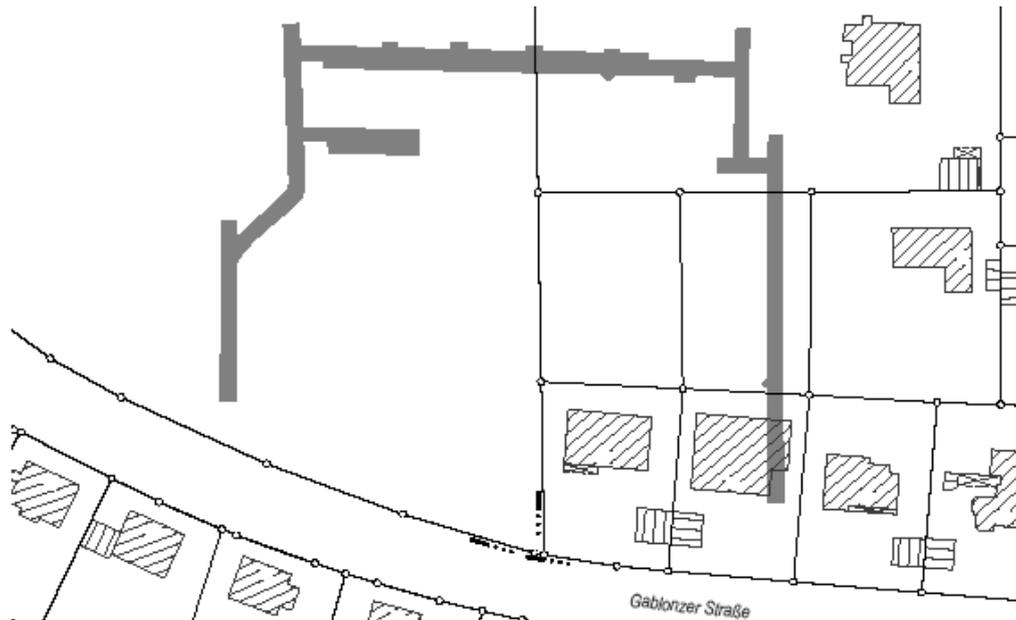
Lageplan Luftschutzstollen SANITÄTSSTOLLEN
